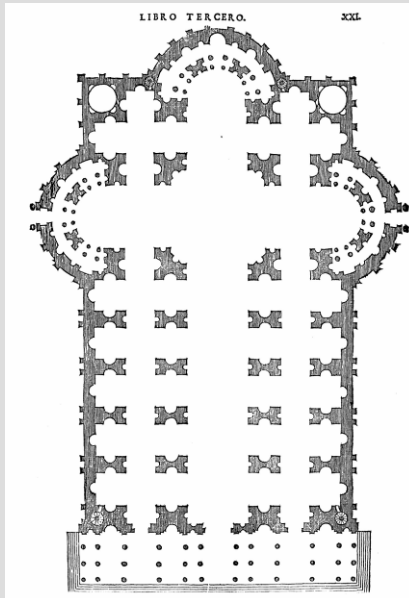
Planta de Rafael Sanzio (Serlio 1552: XX)
